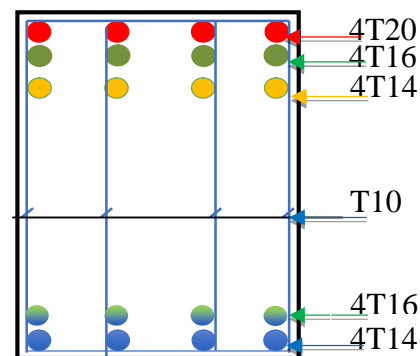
Ferrailage de la poutre de libage (sens transversal)
